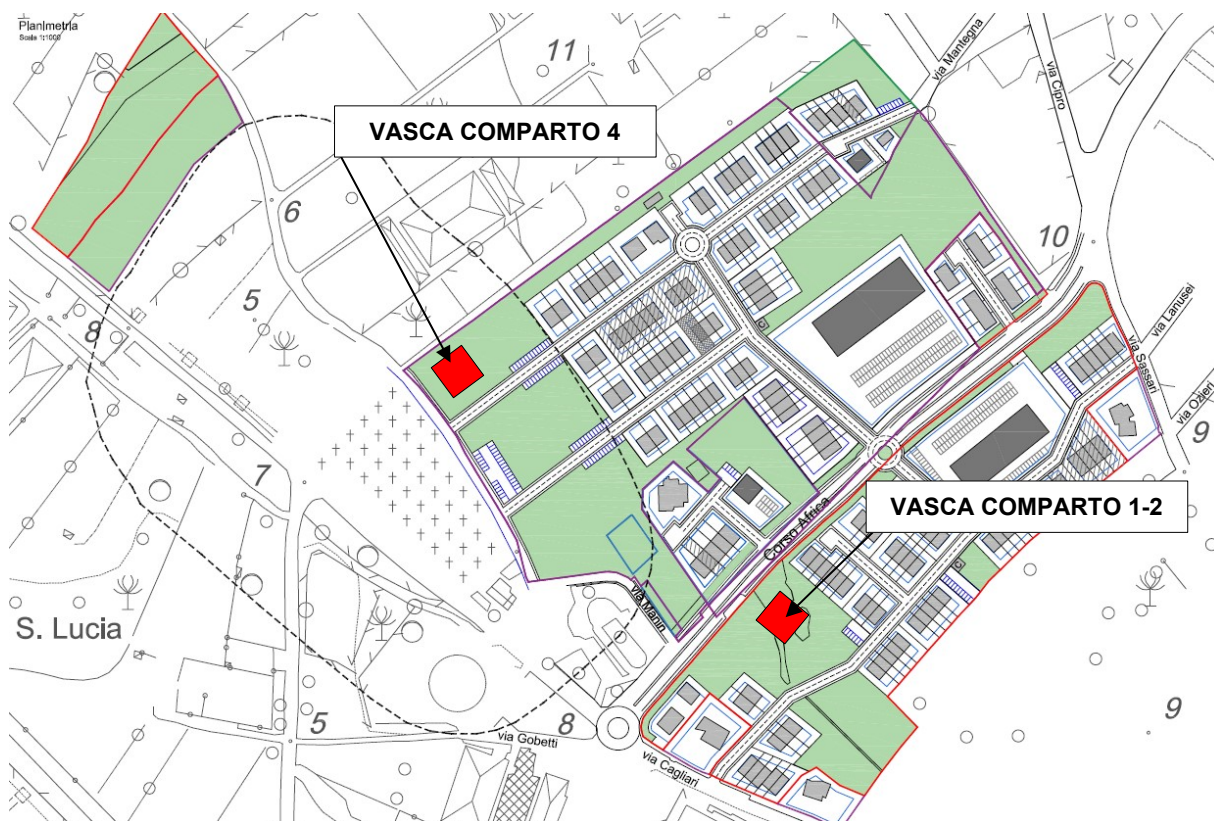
Planivolumetrico di progetto e individuazione delle Vasche di laminazione
